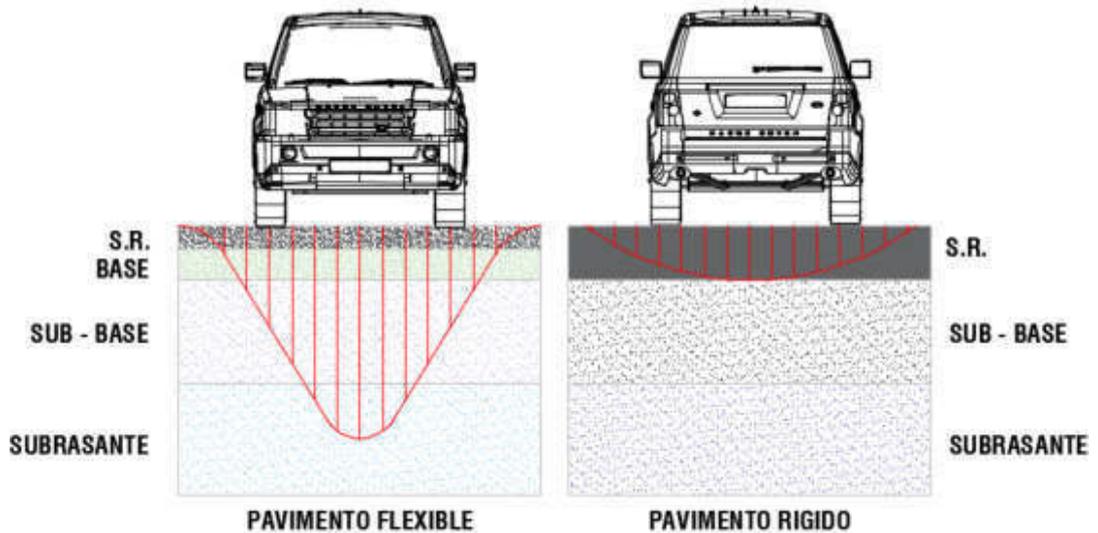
Comportamiento de pavimentos flexibles y rígidos
